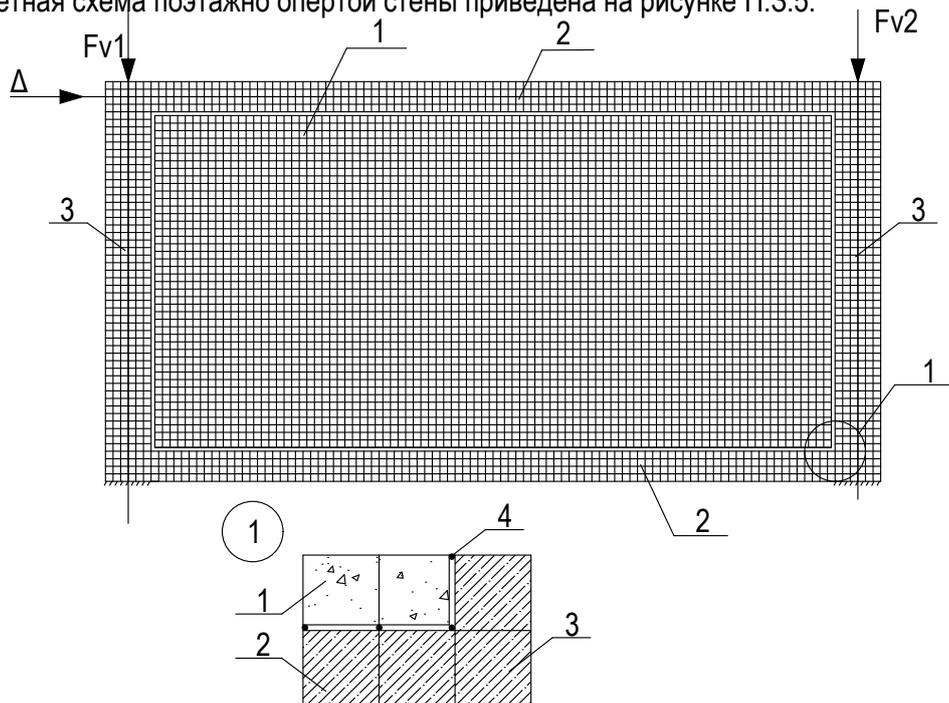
Жесткое крепление элементов кладки стены к элементам каркаса:
